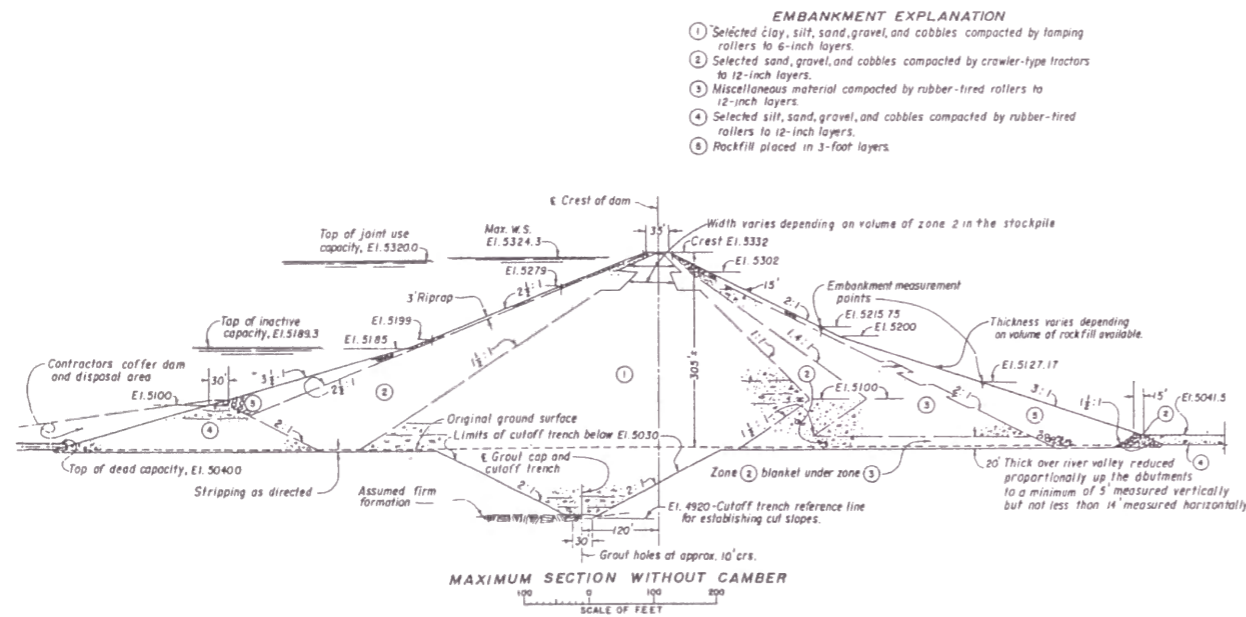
Teton ダムの標準断面図¹²⁶⁾
